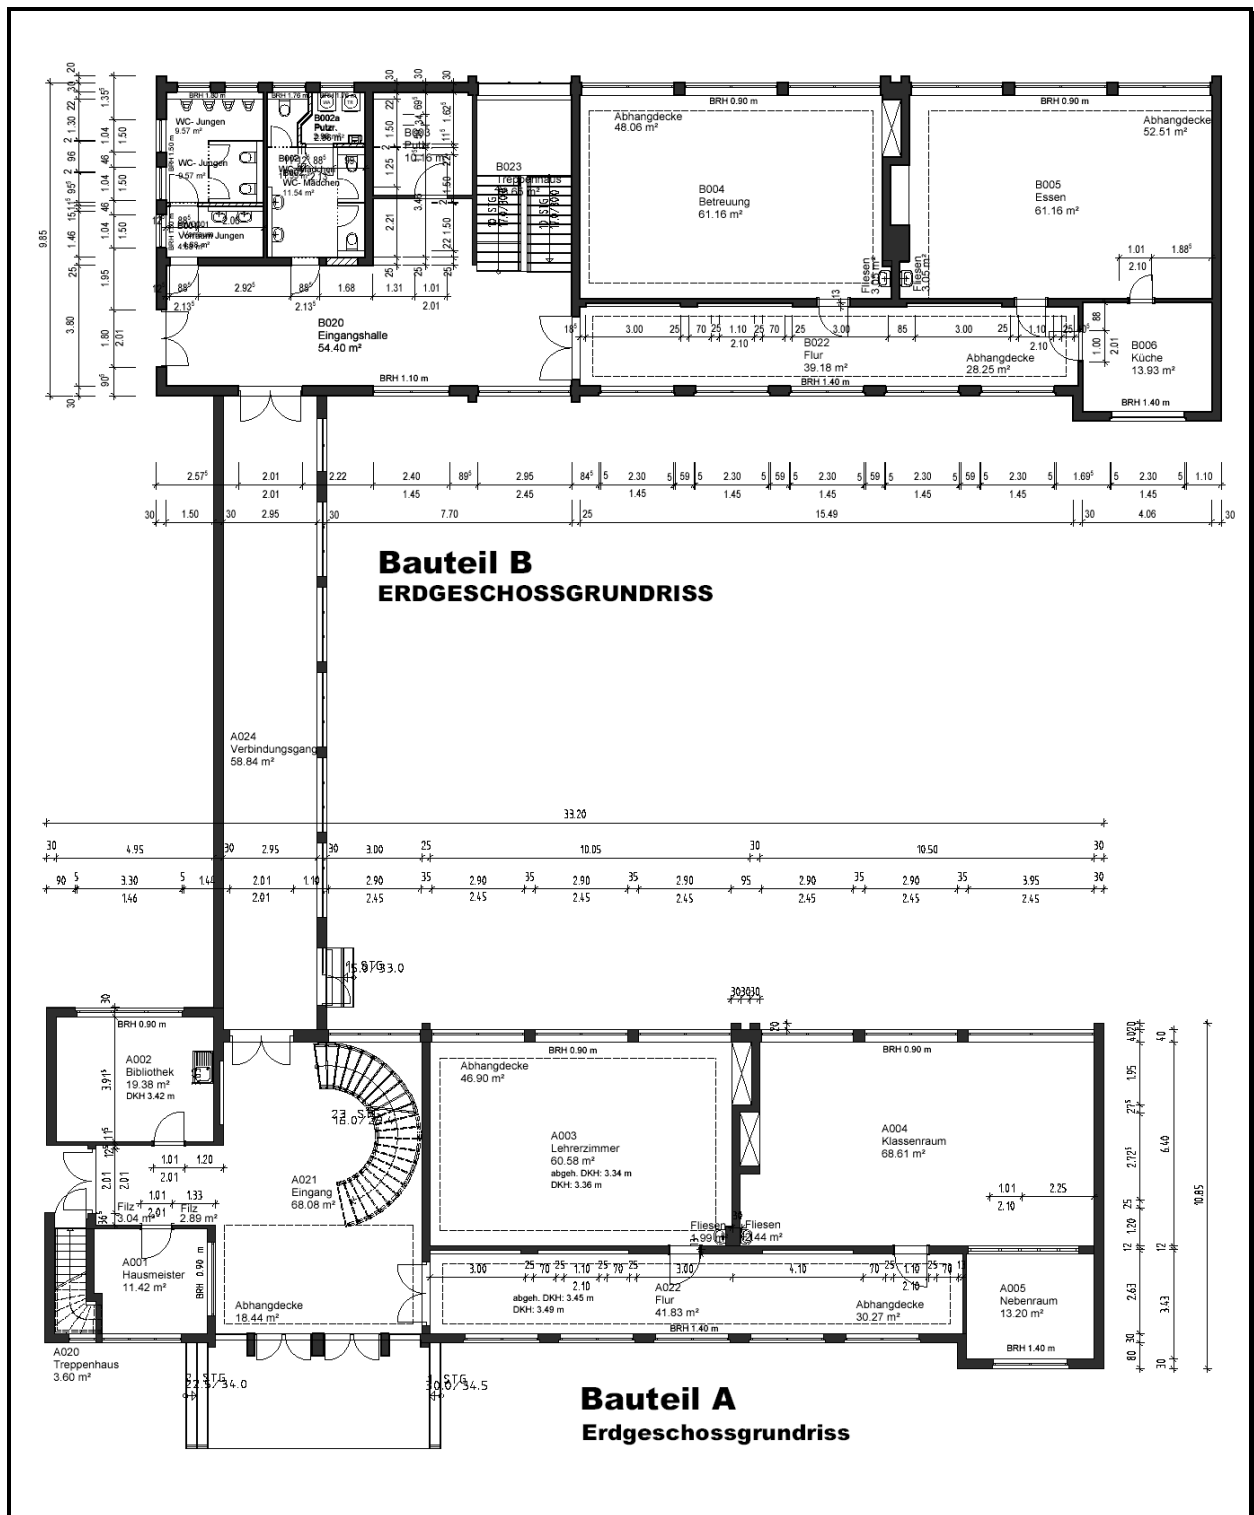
Wendelinusschule: Grundriss Erdgeschoss Bauteile A und B
